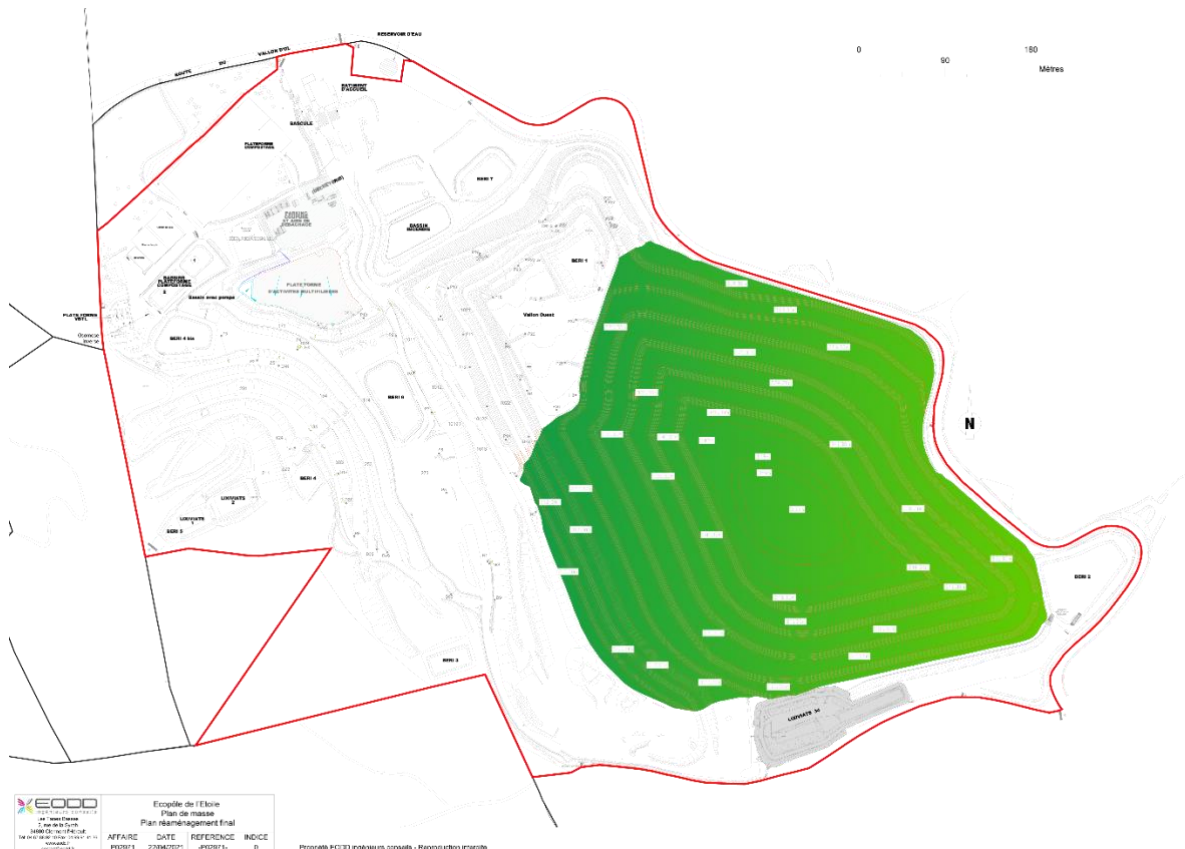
PLAN MASSE FINAL A LA COTE DECHETS 350 M NGF
